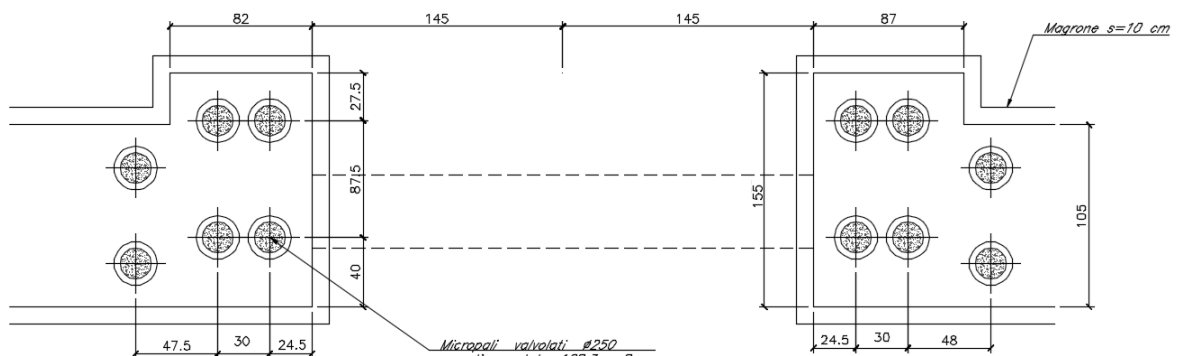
Pianta e prospetto modulo di scavalco BS145-450
